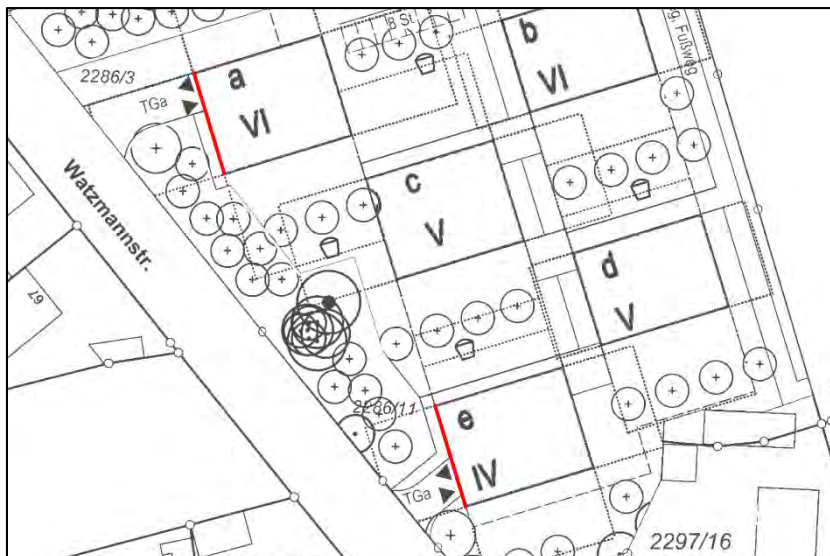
Lageplan mit Kennzeichnung der Fassaden, an denen Schallschutzmaßnahmen für Außenwohnbereiche auf allen Geschossebenen erforderlich sind
